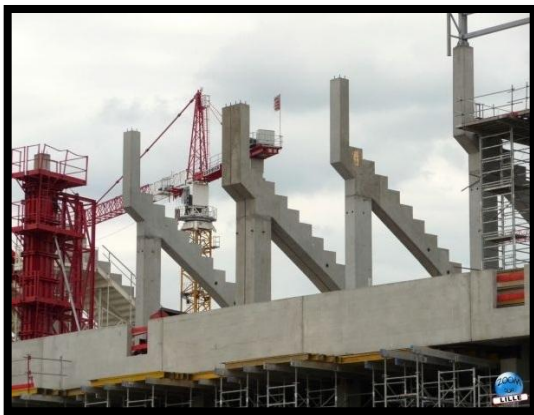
Modèle des poutres de Grand Stade / Stade Pierre Mauroy ¹⁴⁸
